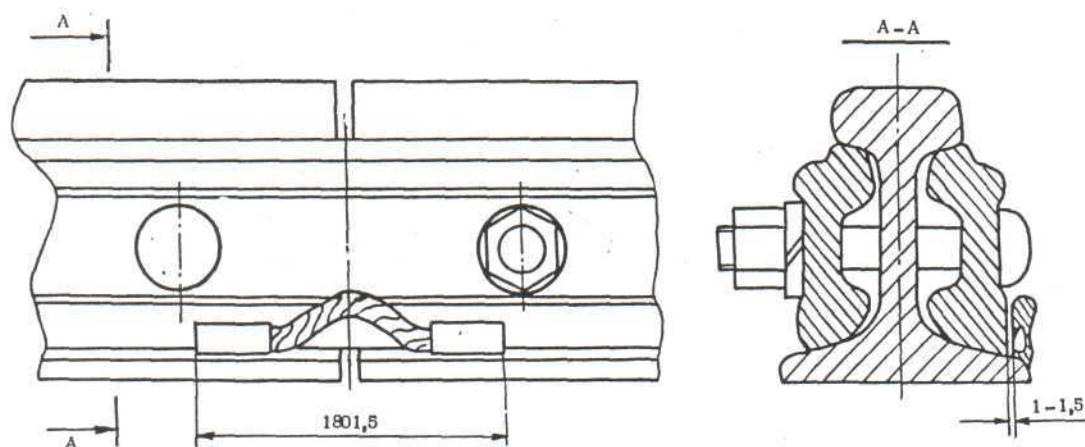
Приварка соединителя с обжатыми наконечниками на верхней грани подшвы объемно закаленных рельсов типов Р65 и Р75
